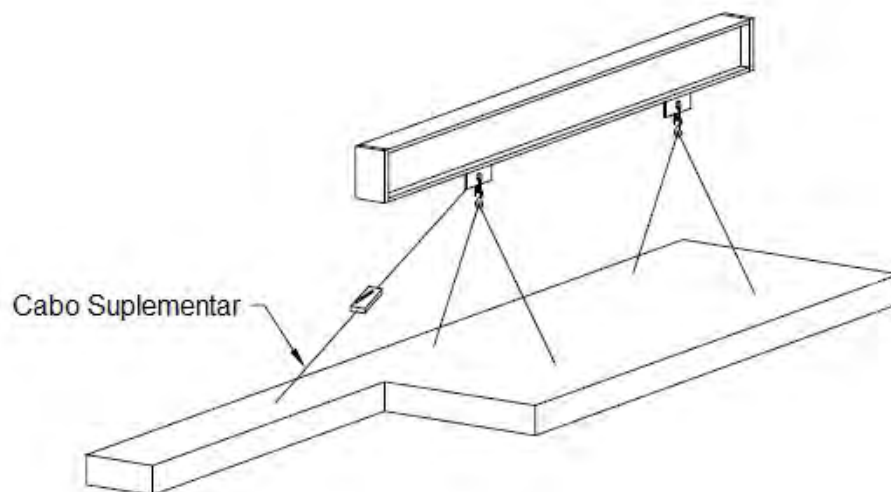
Exemplo de colocação de cabo suplementar para o levantamento de placa de concreto pré-moldado
